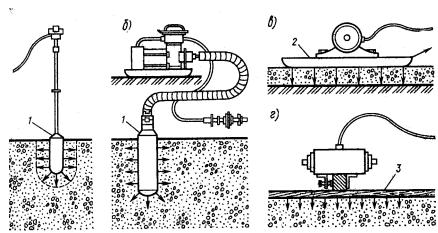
Вибраторы 1 – корпус; 2 – площадка; 3 – опалубка
